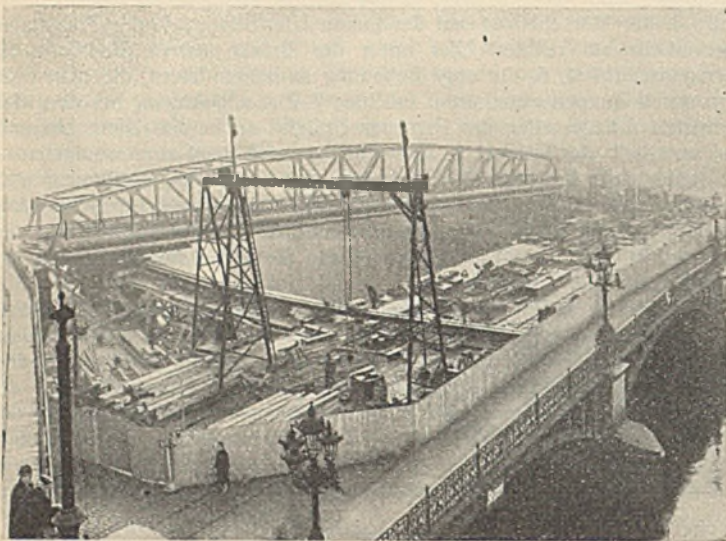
Umbau der Jannowitzbrücke in Berlin. Bauaufnahme. (Im Hintergrund die Notbrücke in Stahlfachwerk.)
